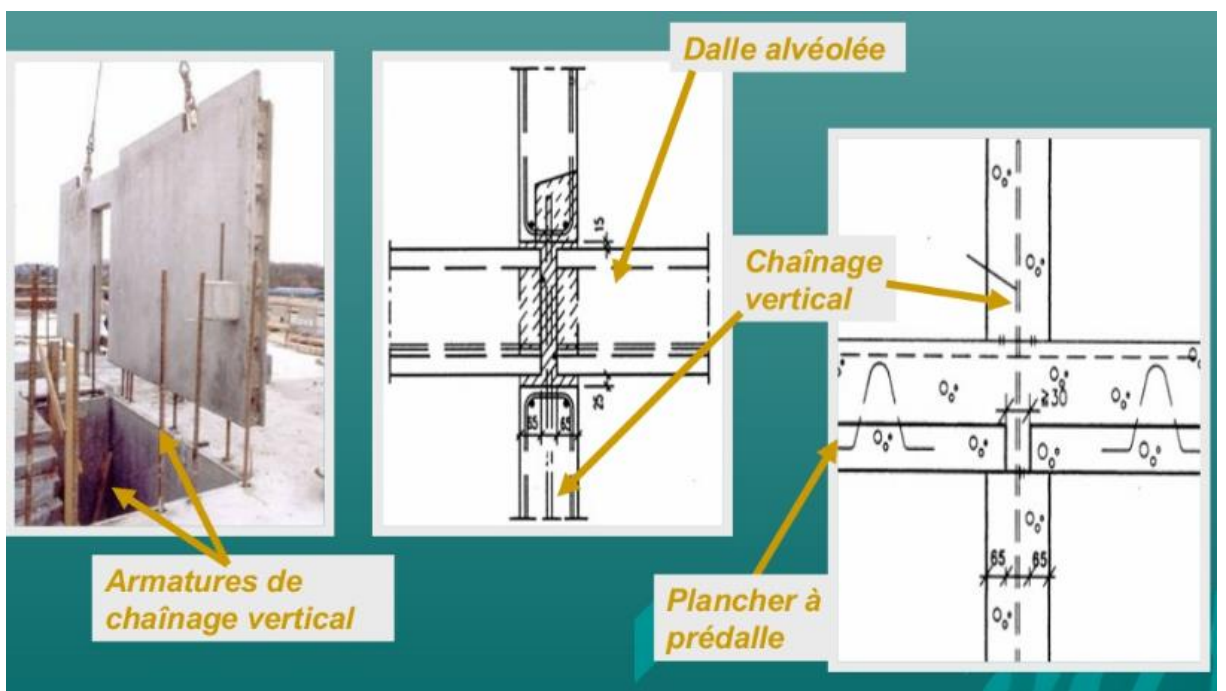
exemple d'assemblage de mur latéraux avec plancher
